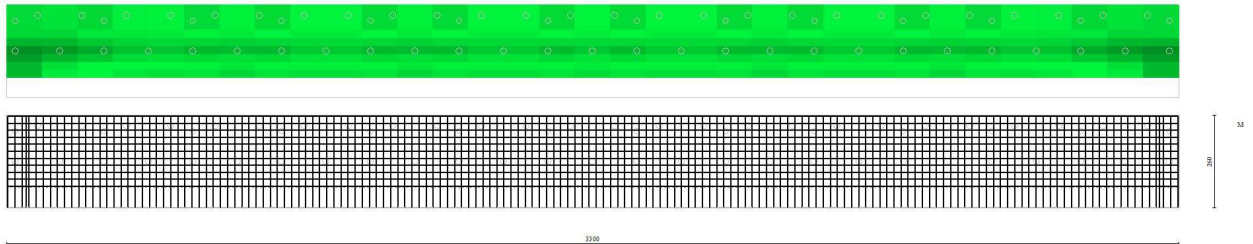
Piastra fondazione dir. Y (Inviluppo)
